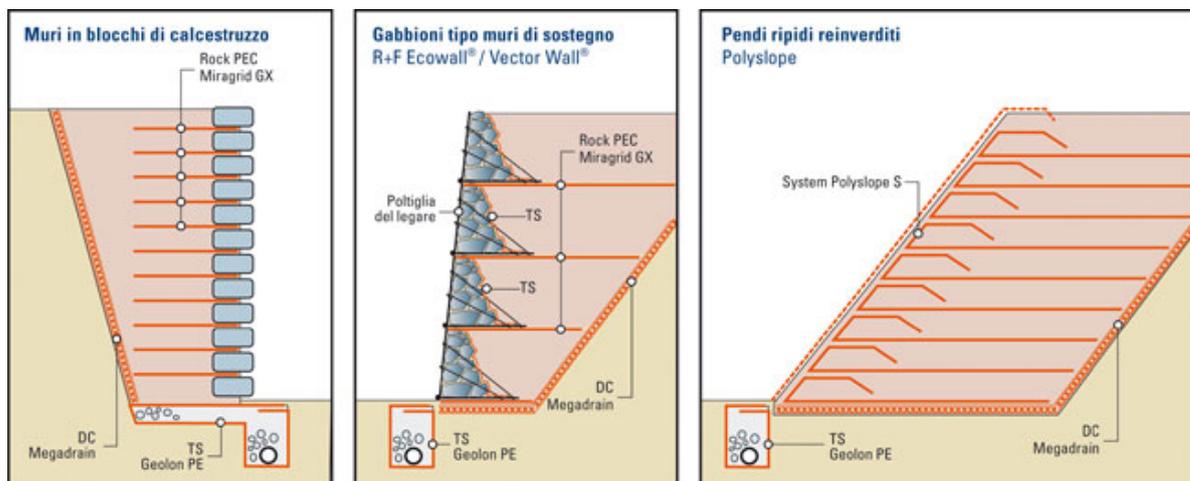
Подпорные стенки из армированного грунта (примеры исполнения и схемы поперечного сечения из зарубежного опыта - Италия)
